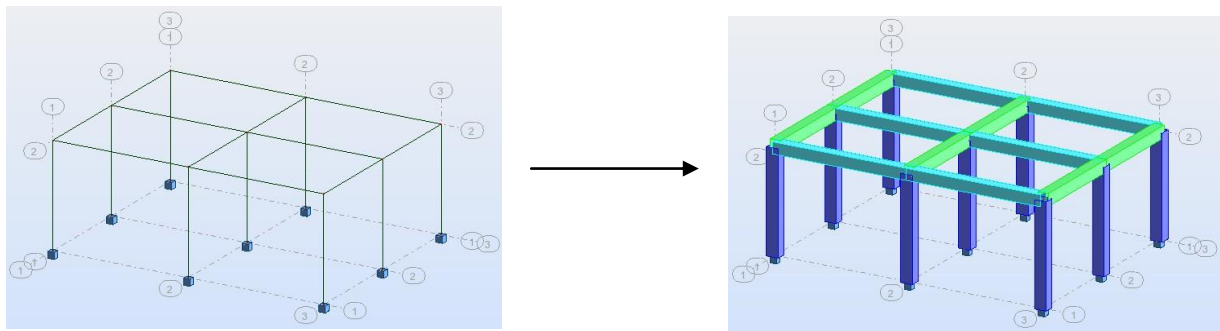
Modélisation des poteaux et des poutres.
